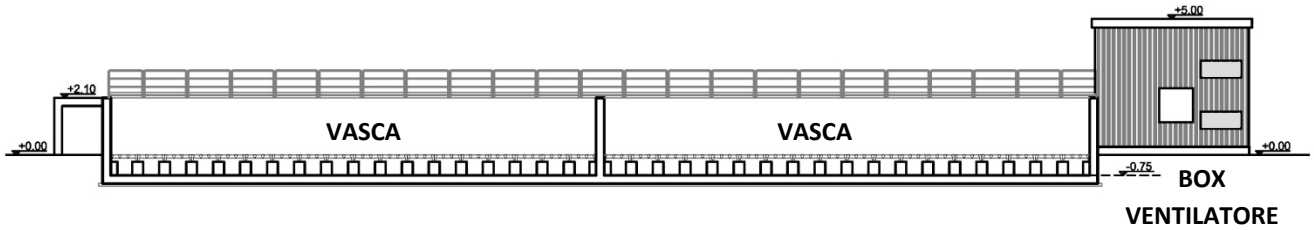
Sezione 1-1: Vista dei sostegni in cemento della pavimentazione grigliata
